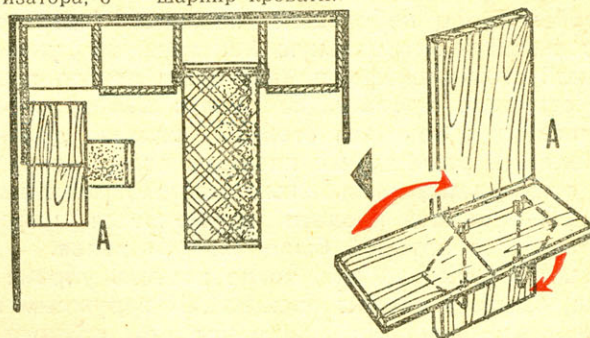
Вид комнаты (в плане) с вечерним вариантом раскладывания стенки: опущена кровать, открыта дверца боковой секции, откинута столешница с кронштейнами.
